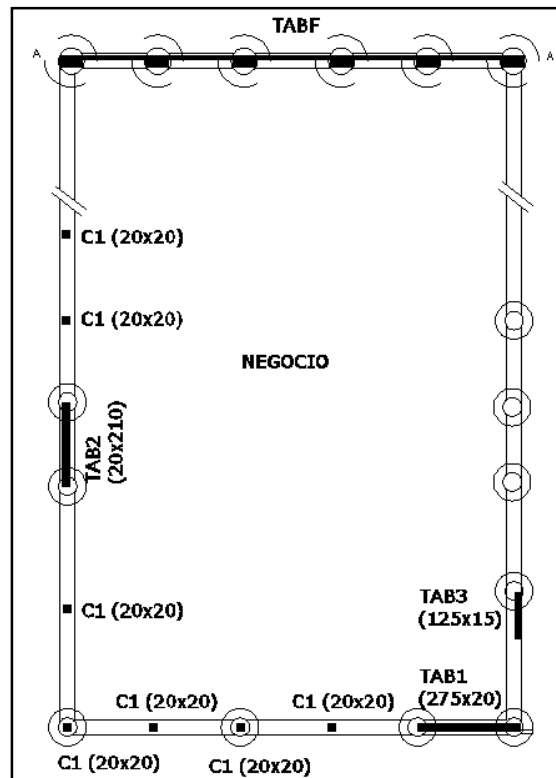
Imagen del plano para ver la disposición y dimensiones de tabiques y columnas.
